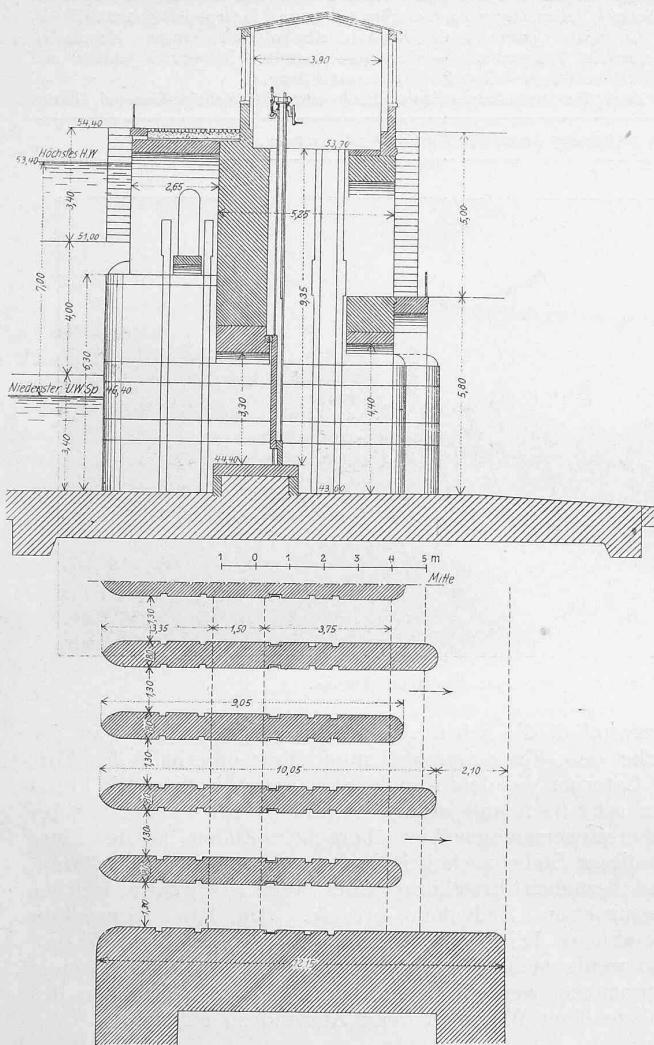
Grundriss und Querschnitt des Kanaleinlaufes. — 1:200.
